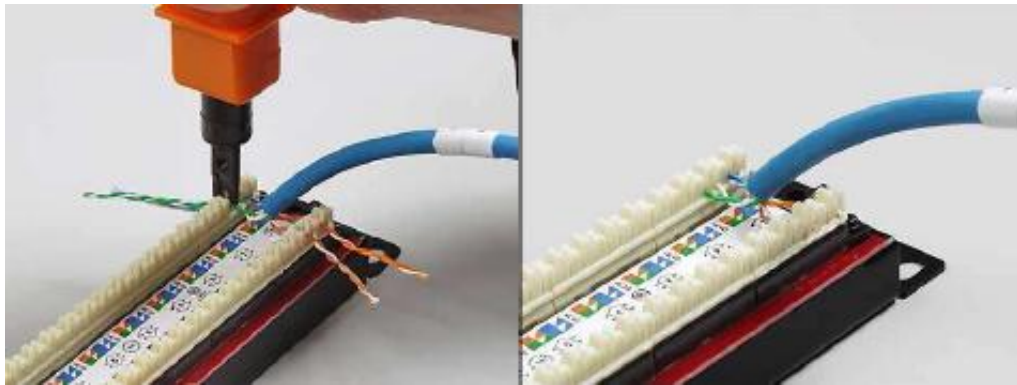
Terminación del ponchado del cable UTP en el patch panel
